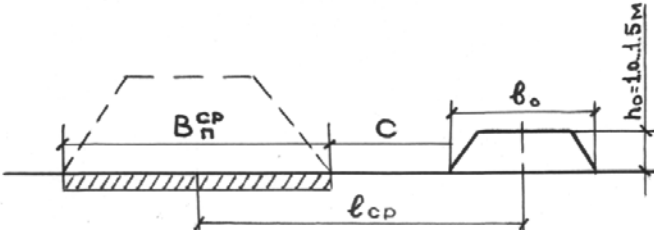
Схема к определению среднего расстояния перемещения грунта при вскрыше основания плотины
